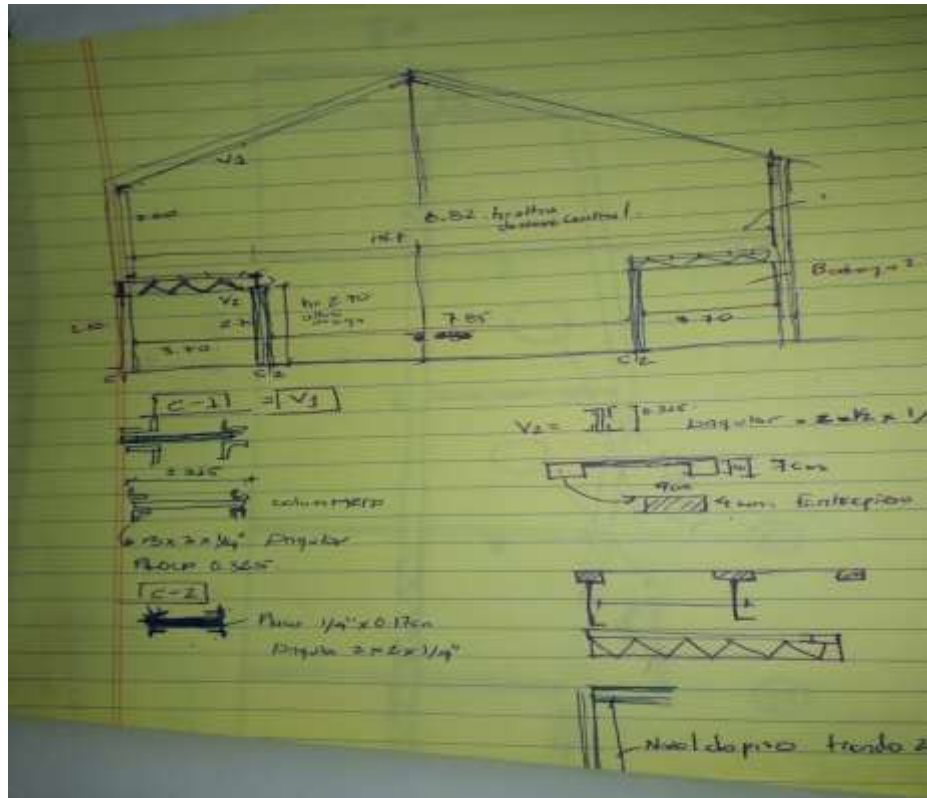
Levantamiento de sección de la tienda .fuente : Elaboración Propia.
